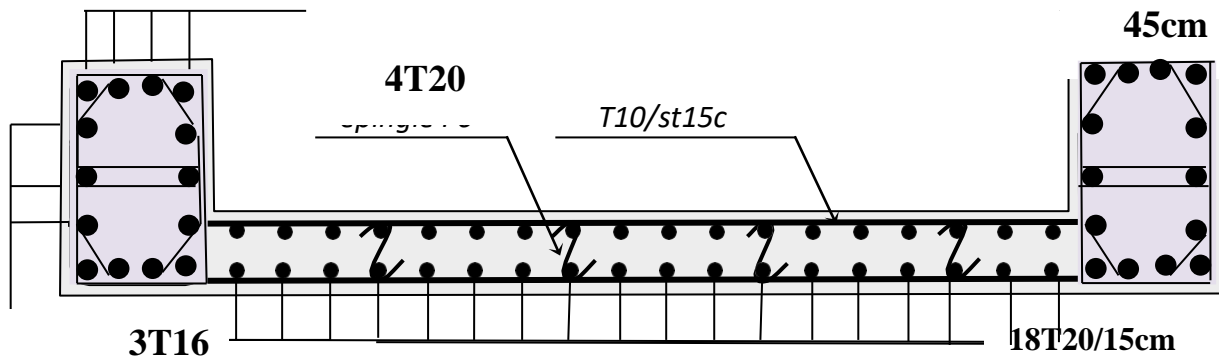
Schéma de ferraillage du voile en U VY3
